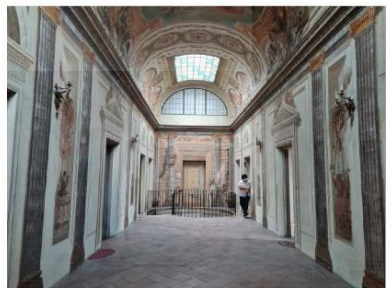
PIANO SECONDO DISIMPEGNO CENTRALE
